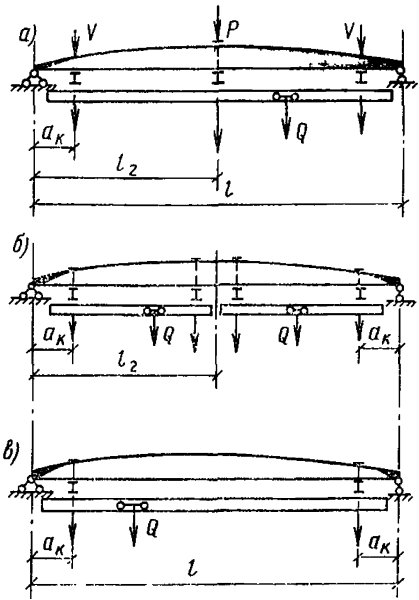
Типовые схемы нагружения (а, б, в) покрытия из панелей-оболочек КЖС подвесными кранами
